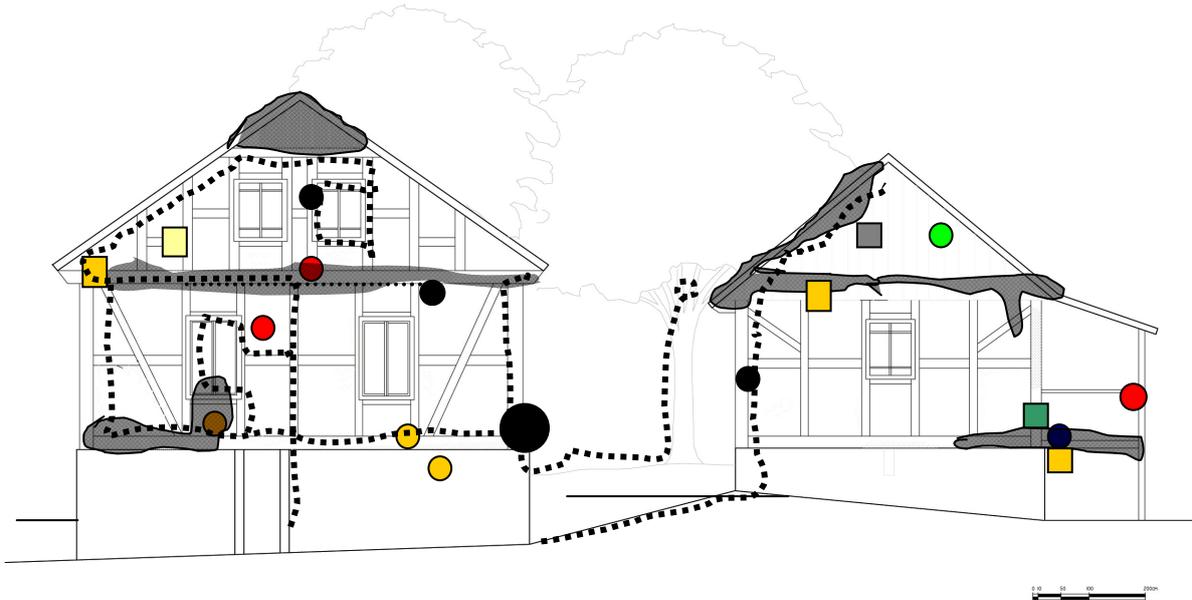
Fachwerkbau, Haus mit Küchengebäude nebenan
